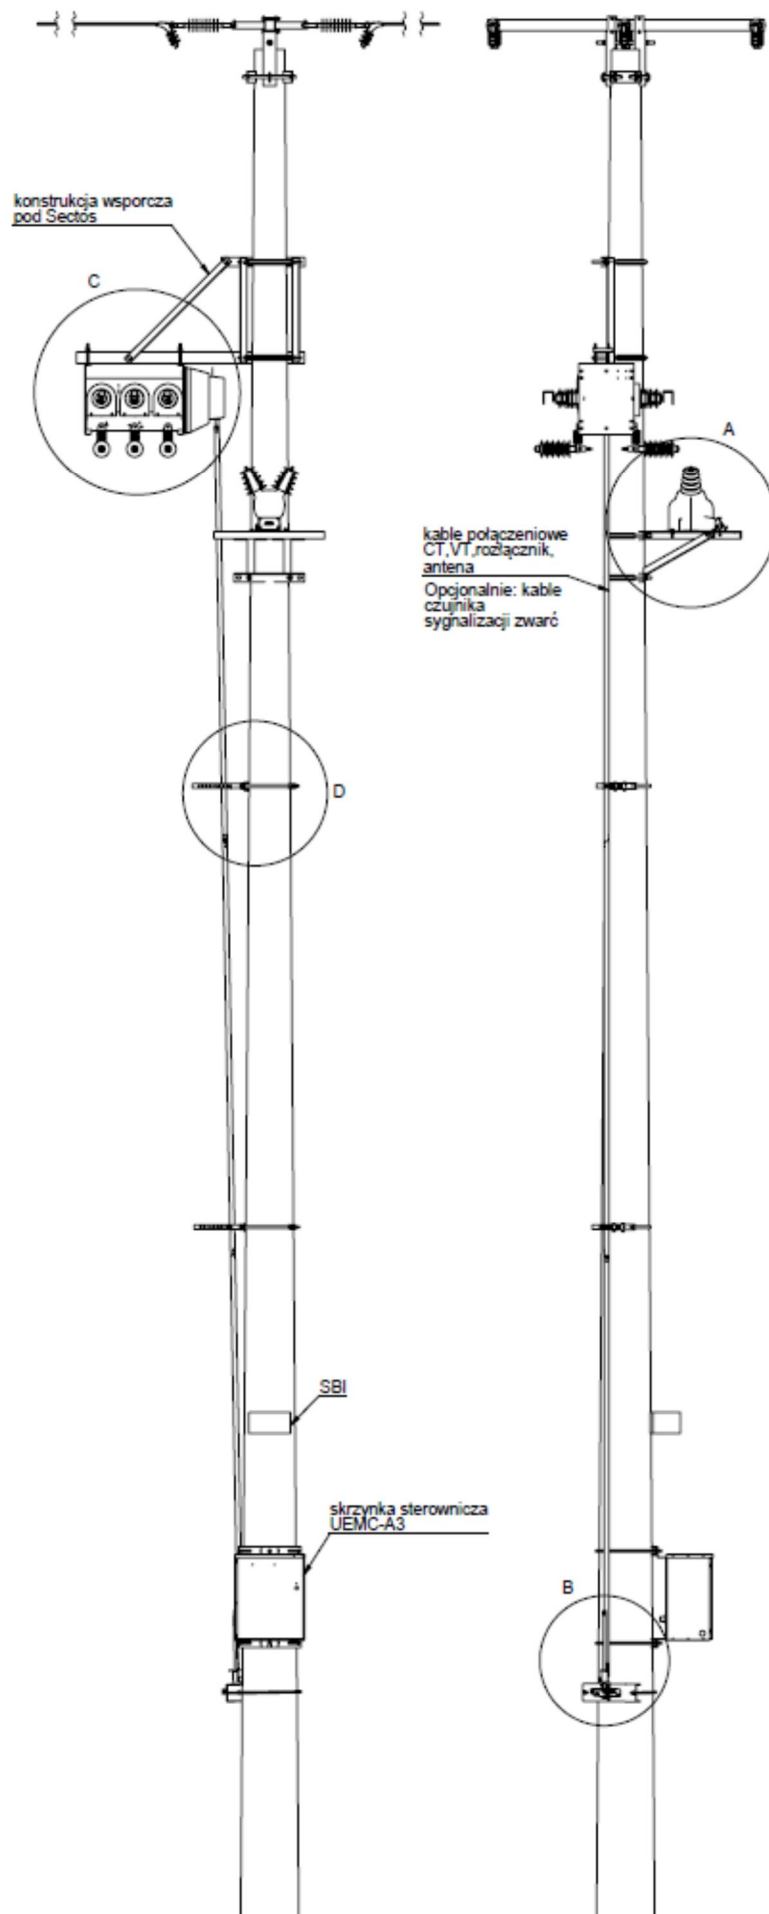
Montaż NXB na 2 słupach okrągłych betonowych, poniżej poprzeczki, działanie ręczne dźwignią.
